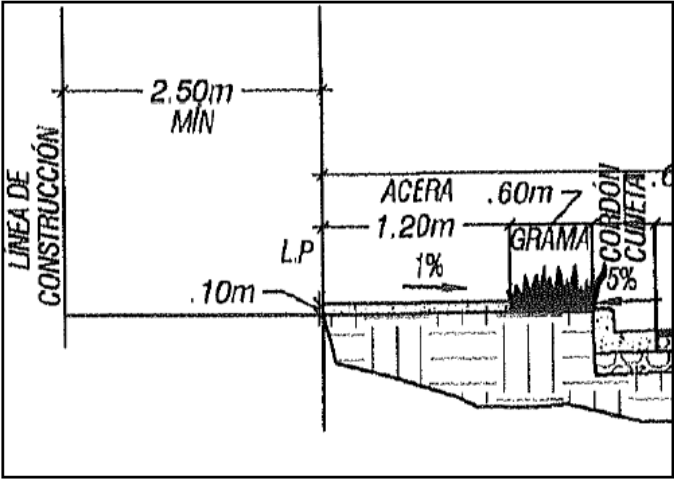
Detalle de acera. Fuente: Planos de anteproyecto
